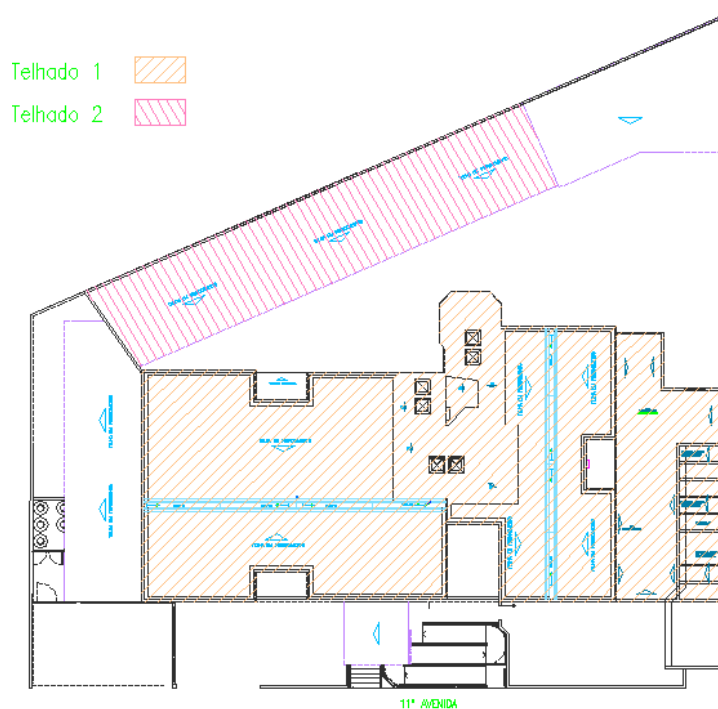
Planta das áreas de contribuição. Fonte: o(s) autores(a).
